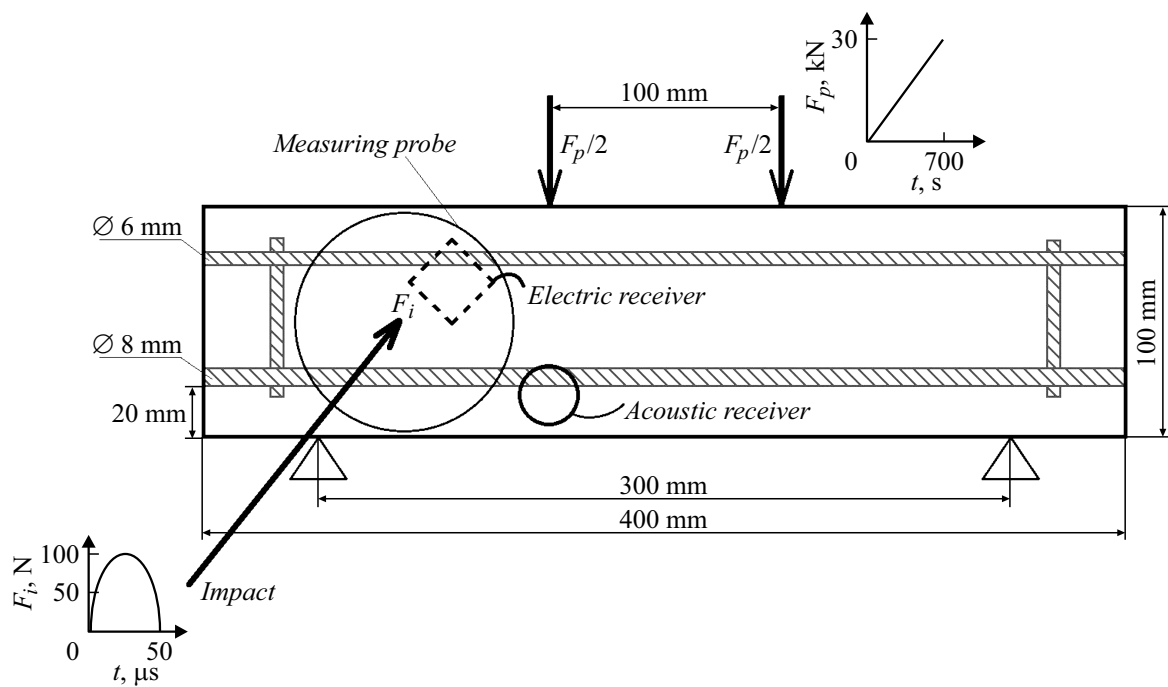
Схема испытания армированных бетонных балок на изгиб.
